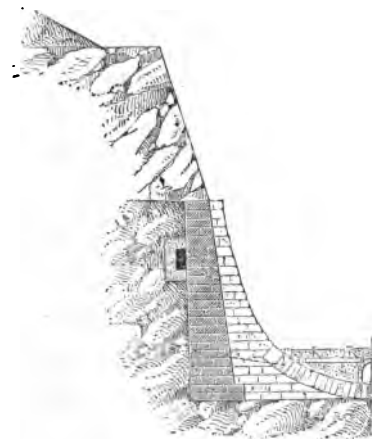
Tranchée consolidée par des murs de soutènement et des voûtes renversées.
